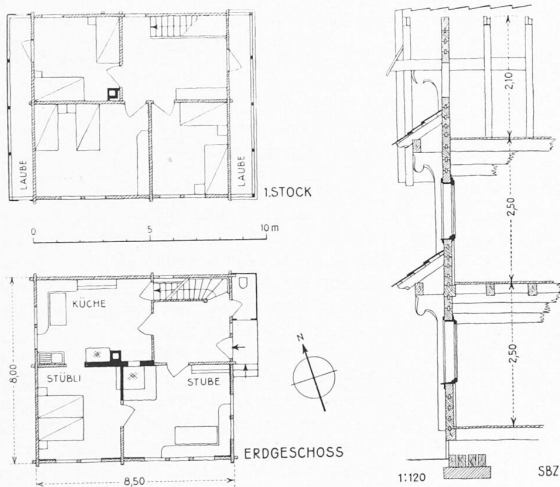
Bergbauernhaus, Grundrisse 1 : 300, Schnitt 1 : 120
